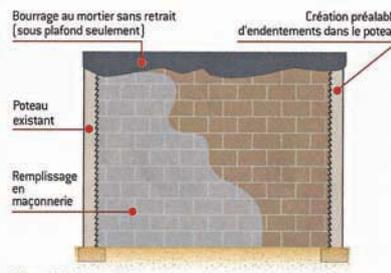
Création d'un mur en maçonnerie entre 2 poteaux existants (élévation)
